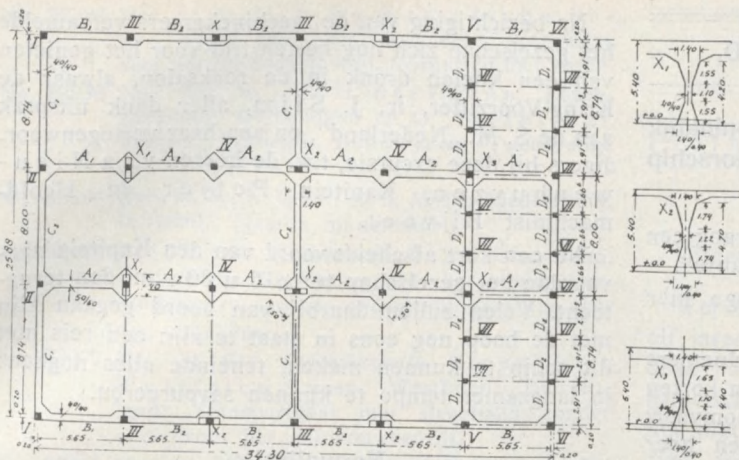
Funderingsplan gewapend beton winkelgebouw te San José, Costa Rica en aanzicht 3-tal kolommen (1:500).
